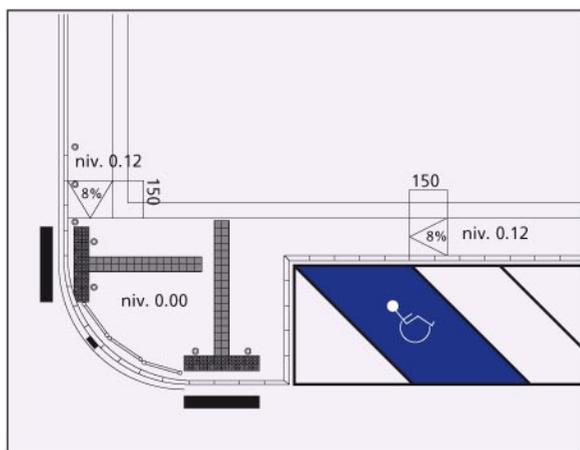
vue en plan d'une inflexion généralisée. © GAMAH
